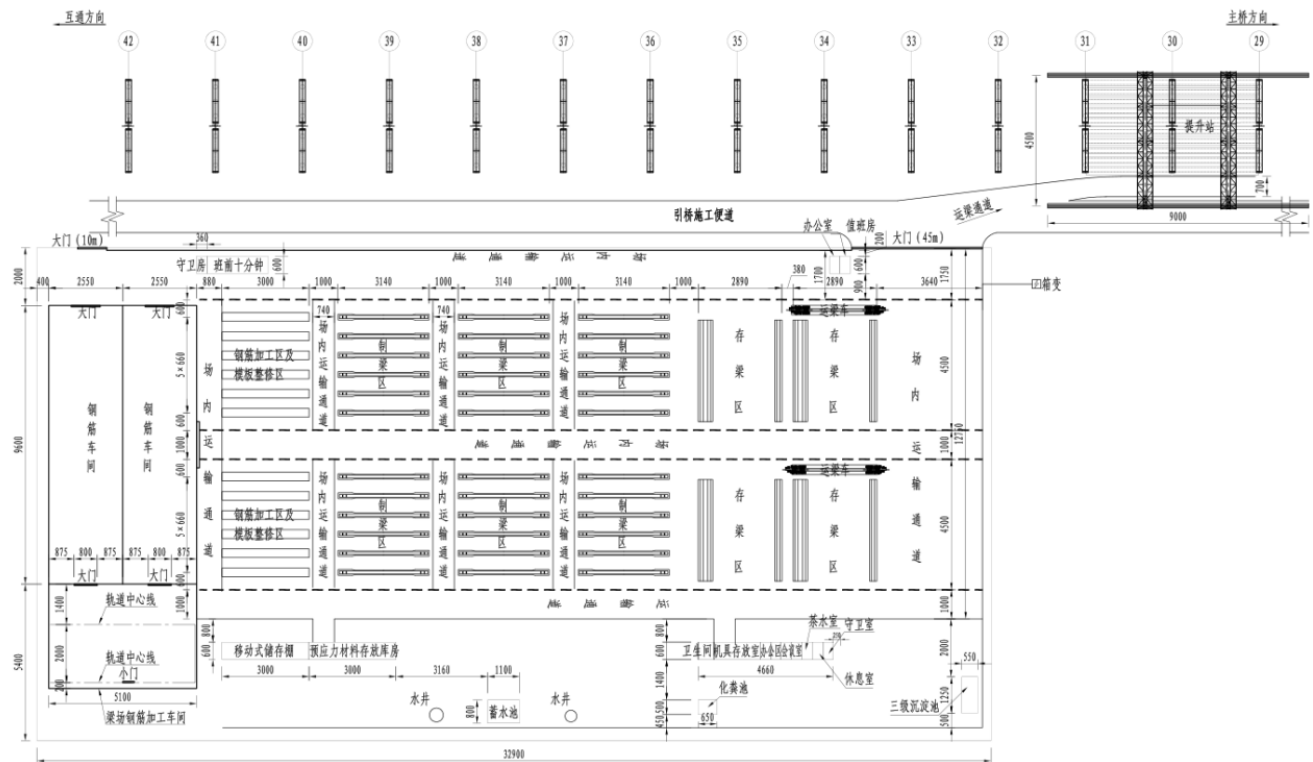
北岸小箱梁预制场平面布置图（单位：m）
